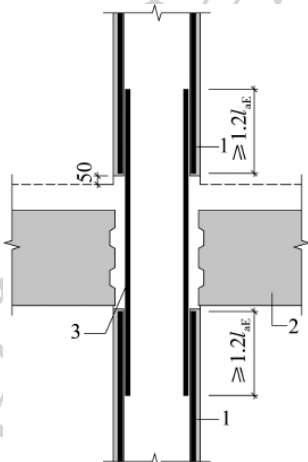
叠合柱纵筋搭接连接构造示意图
